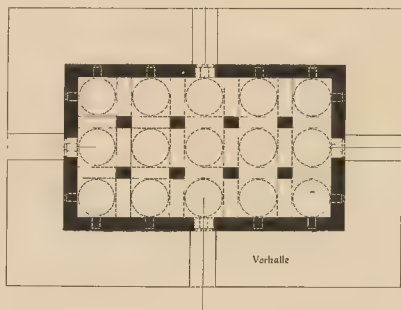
Der Große Besestan. Grundrisskizze.
